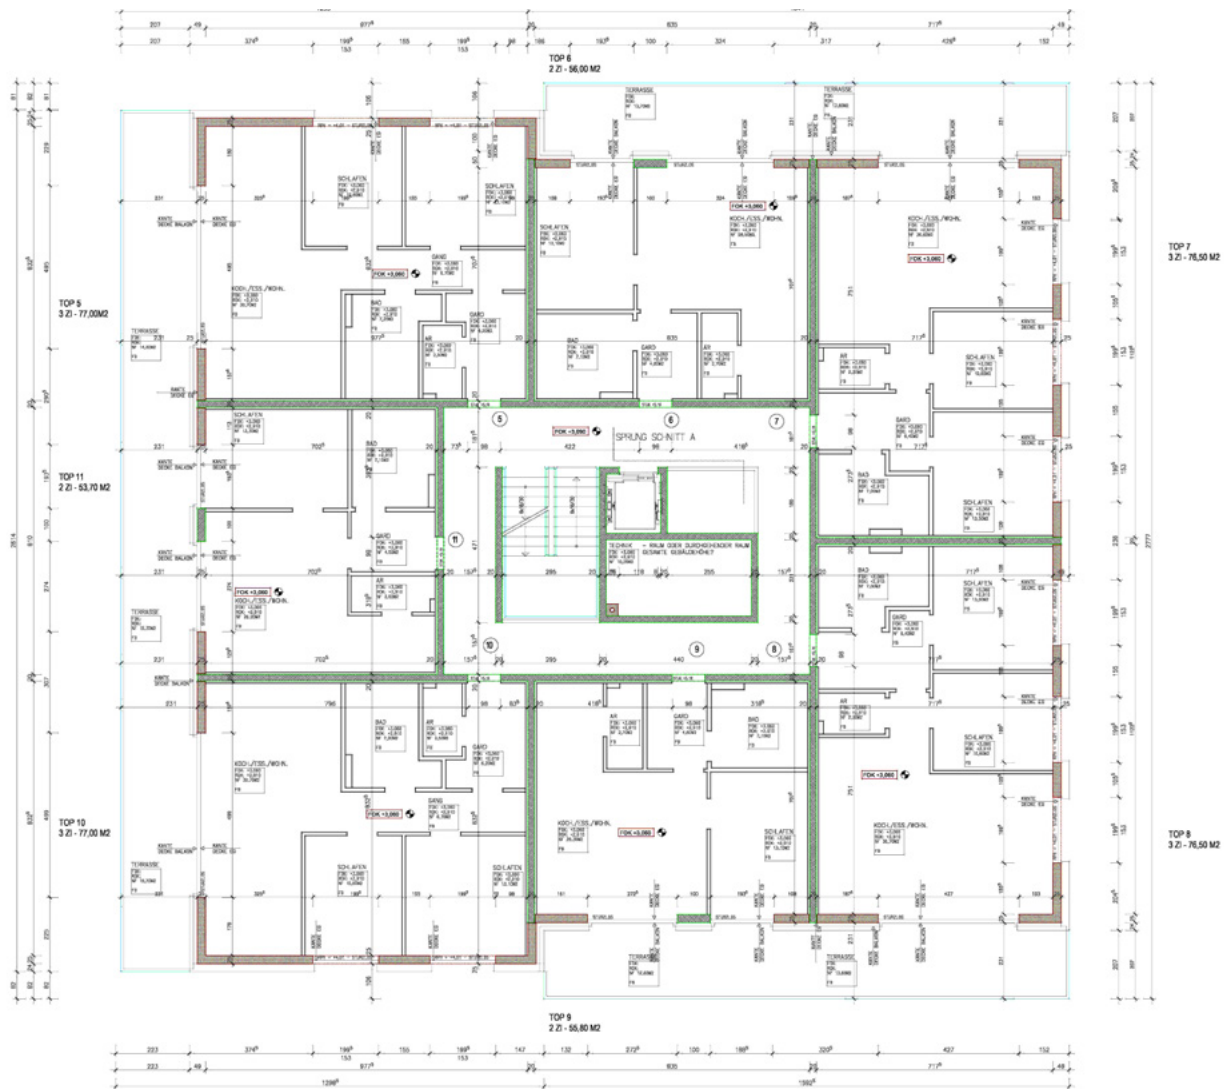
Grundriss EG (Quelle: Arch. Walser + Werle, Feldkirch)
